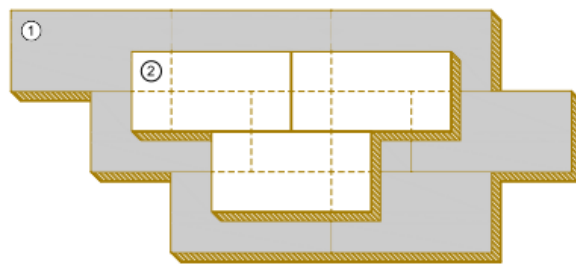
Смещение плит верхнего и нижнего слоев при укладке. 1 – нижний слой плит; 2 – верхний слой плит.
